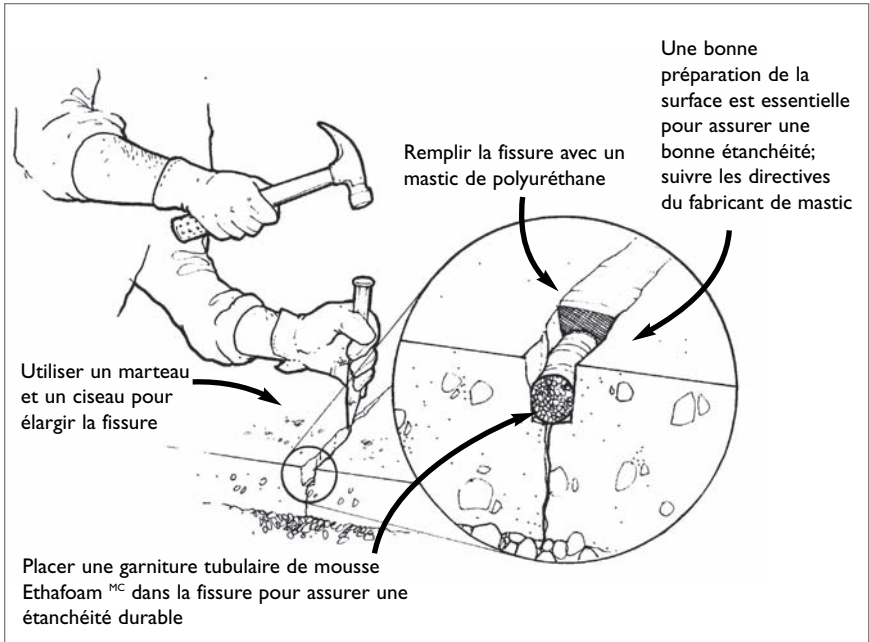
Obturation des fissures dans les murs de fondation et les planchers
